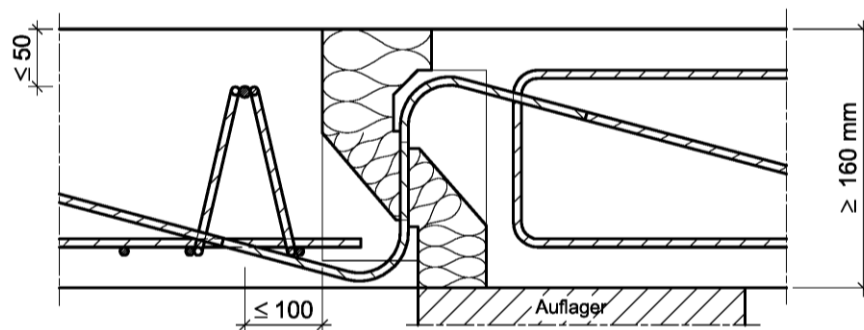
Beispiel Schöck Isokorb® Typ V mit Vertikalbewehrung
